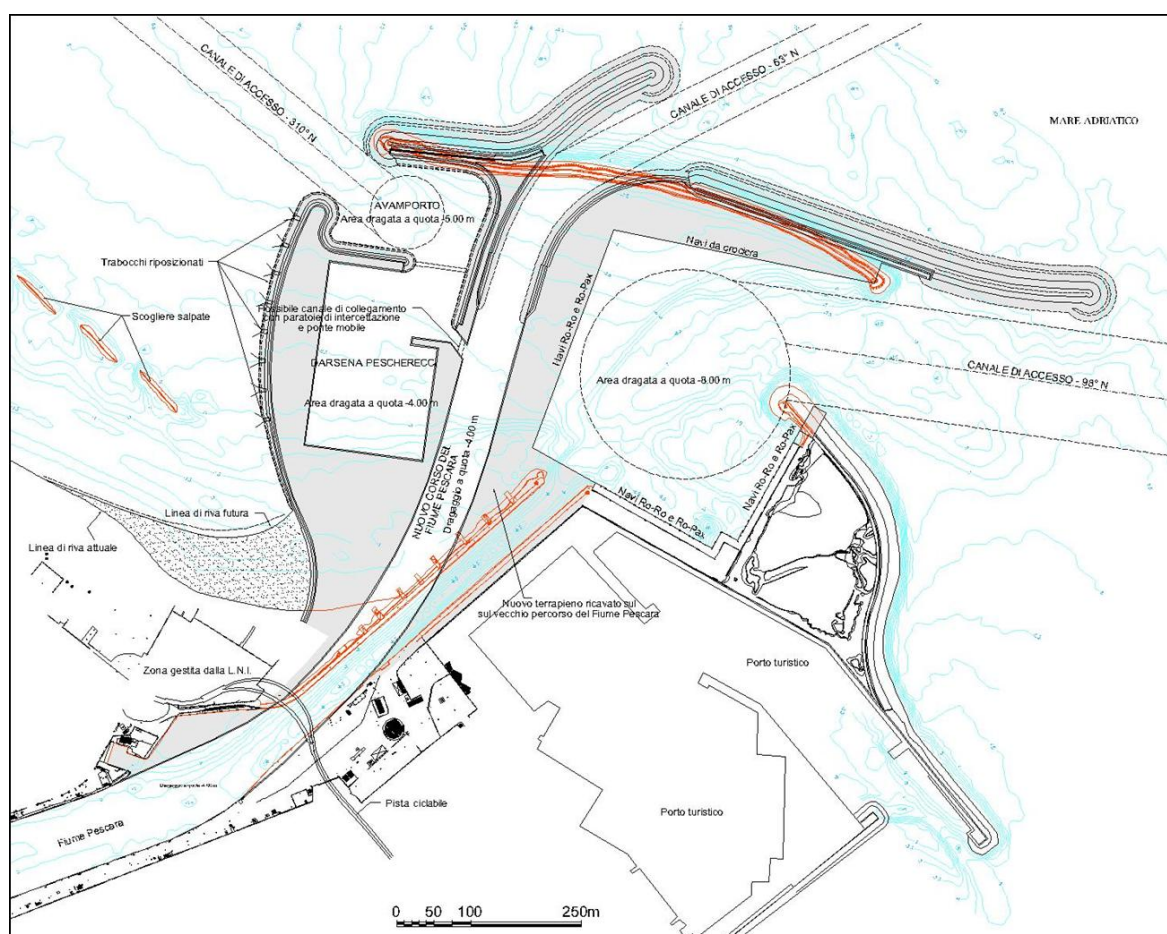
Sovrapposizione del nuovo progetto con l'attuale struttura portuale (rosso).
